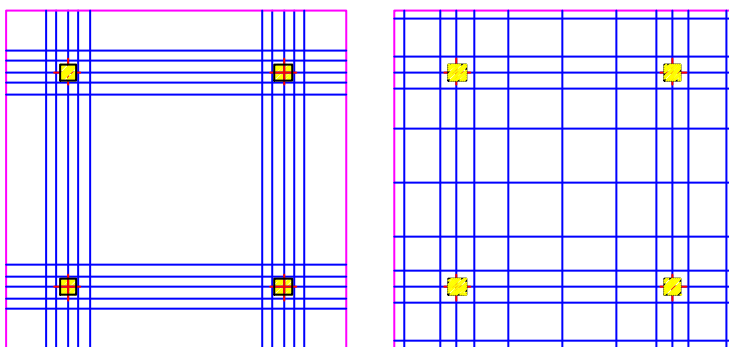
Lajes Maciças Bidirecionais + Vigas
